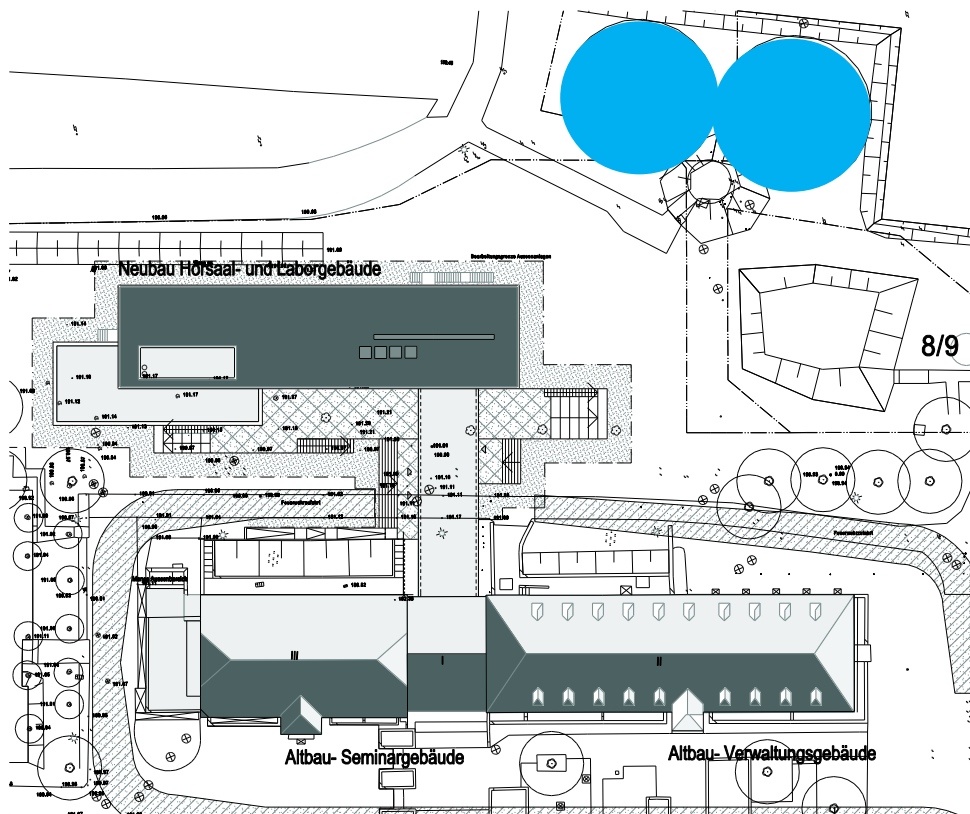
Lageplan mit markierten Regenwasserzisternen Ausschnitt aus [40]
